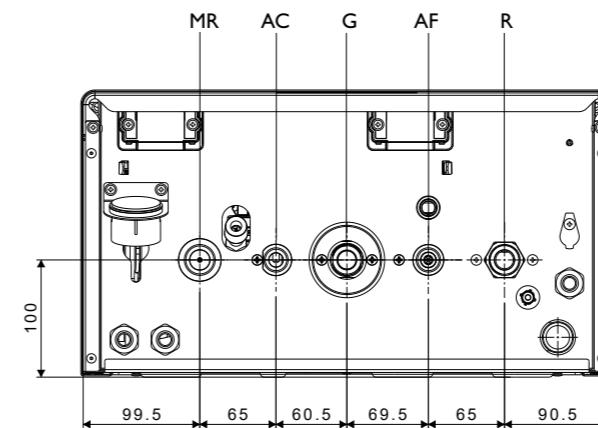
Vista dal basso - Schema connessioni idrauliche
